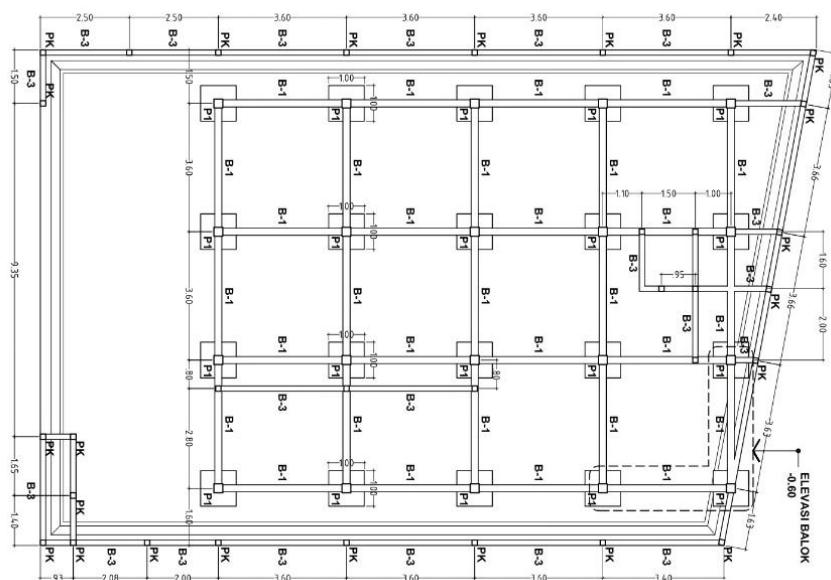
Detail Kolom dan Balok Gedung Serbaguna RW. XII Merjosari
